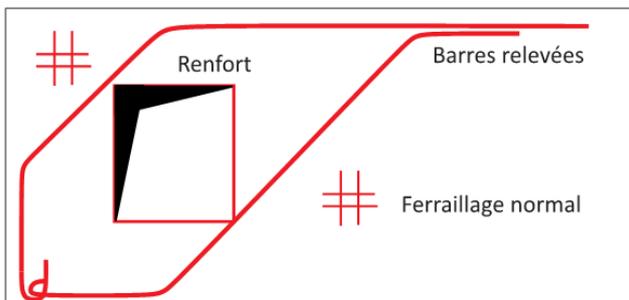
Exemple d'un schéma des bielles-tirants d'un mur
